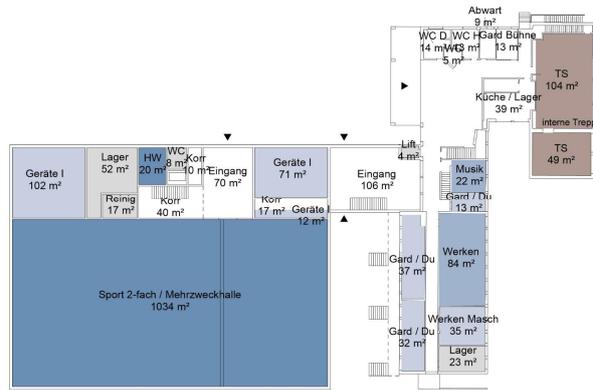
Erdgeschoss Turnhalle, Variante «gelb»
